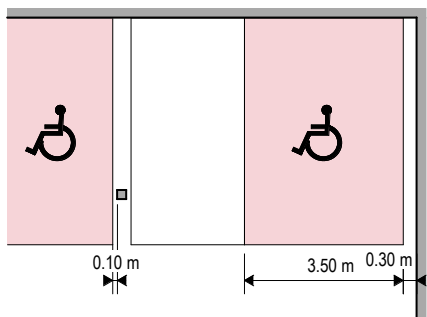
Distanze degli stalli di parcheggio adatti alle sedie a rotelle dai pilastri e dai muri adiacenti
